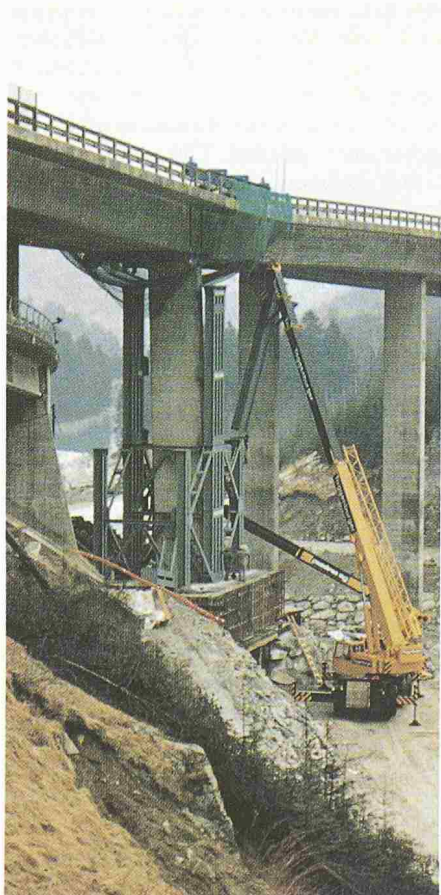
Montage des Stahlgerüsts mit Pneukran ab Baupiste linkes Reussufer
